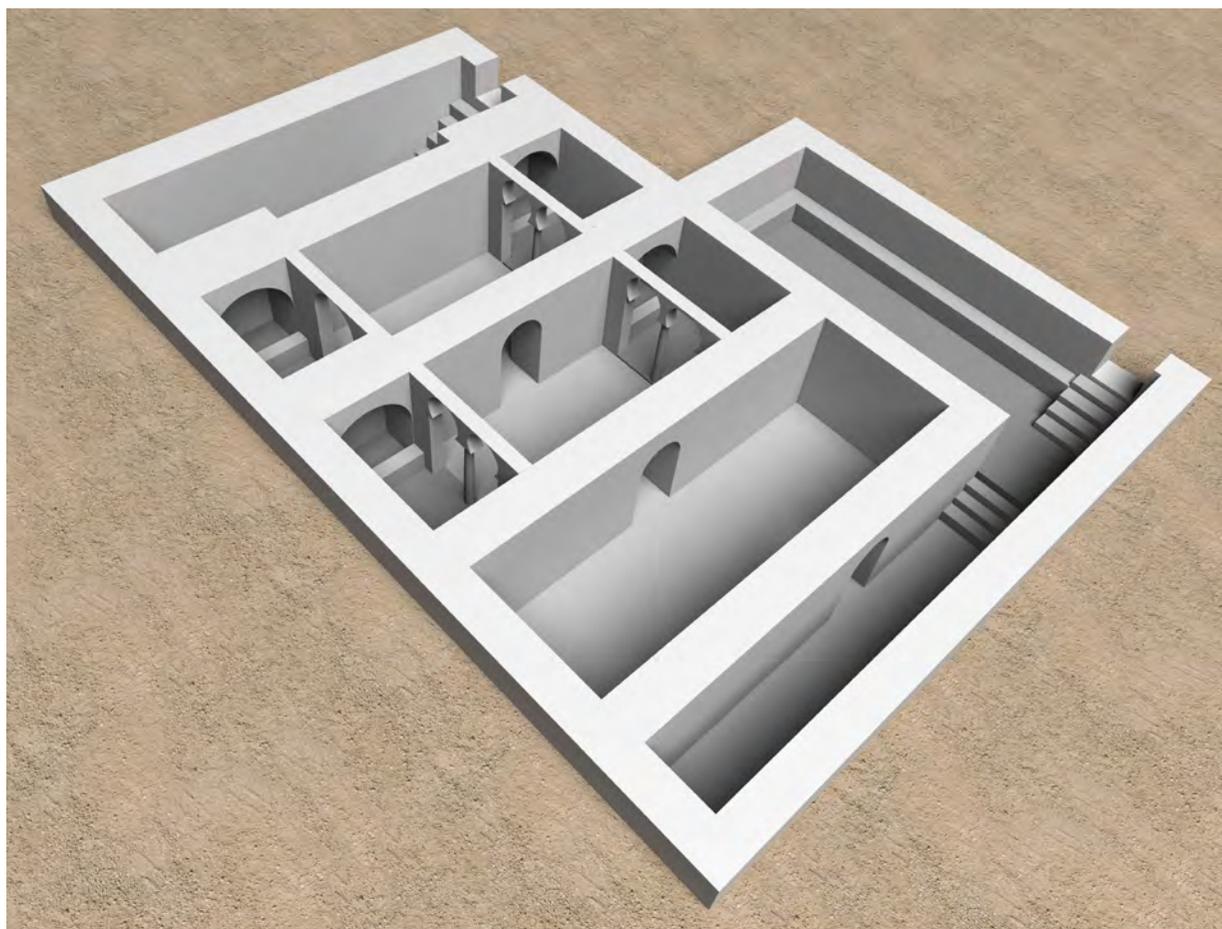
Propuesta de reconstrucción 3D del hammām. Con sección longitudinal.
